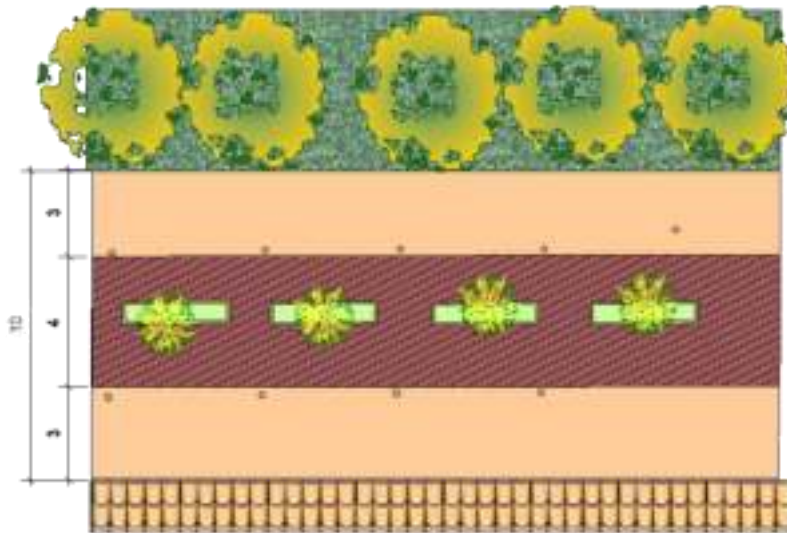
Propuesta Perfil de Vía Calle Antonio J.
